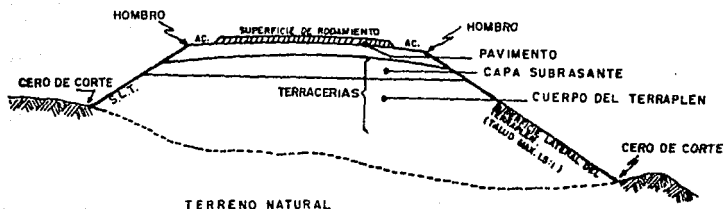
Sección transversal típica en corte, para carreteras de dos carriles.
